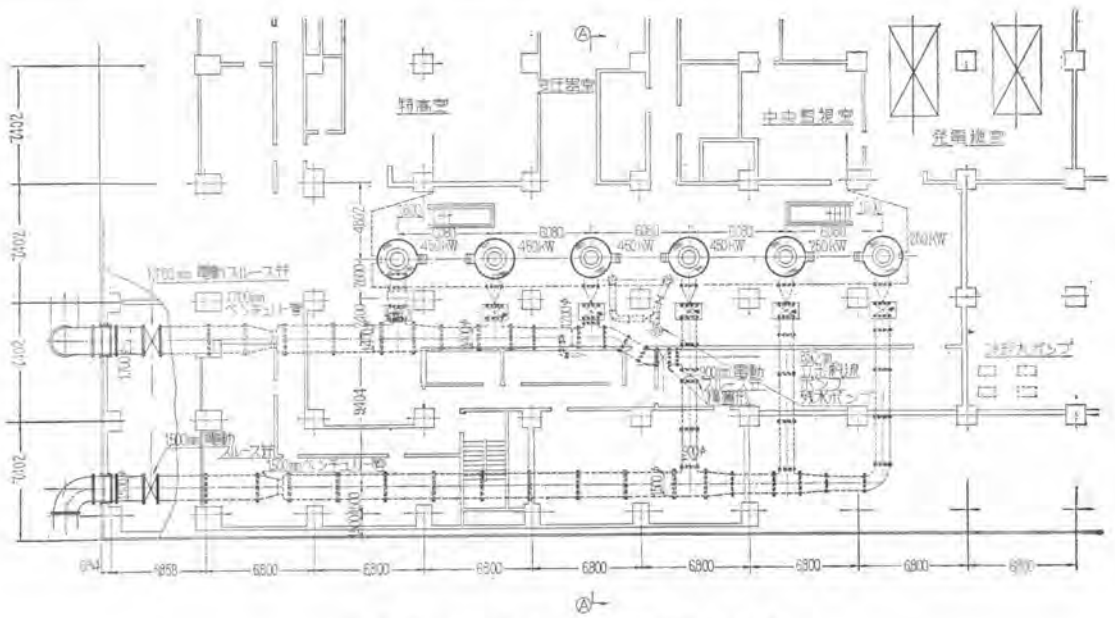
東京都下水道局銭瓶ポンプ場ポンプ室平面図
